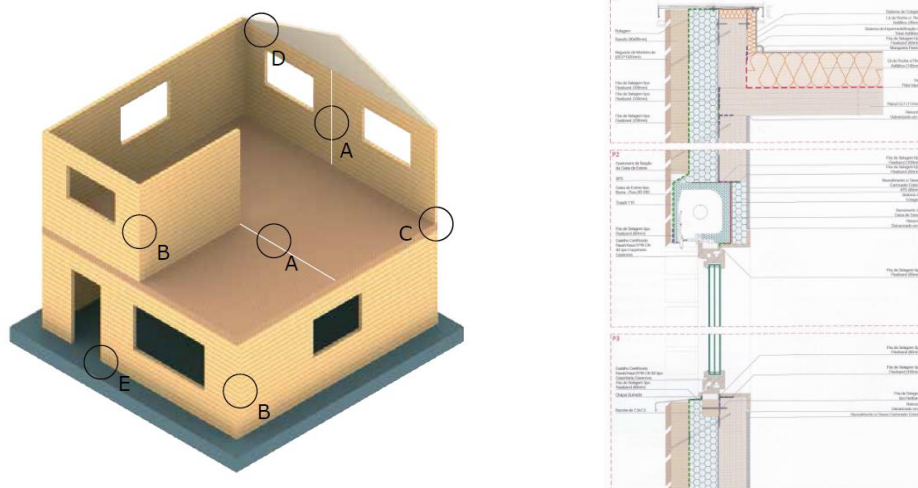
Edifício típico de dois pisos com painéis lamelados colados cruzados (Karacabeyli & Douglas, 2013) e pormenor construtivo tipo de fachada ventilada com estore (TISEM, 2005).
